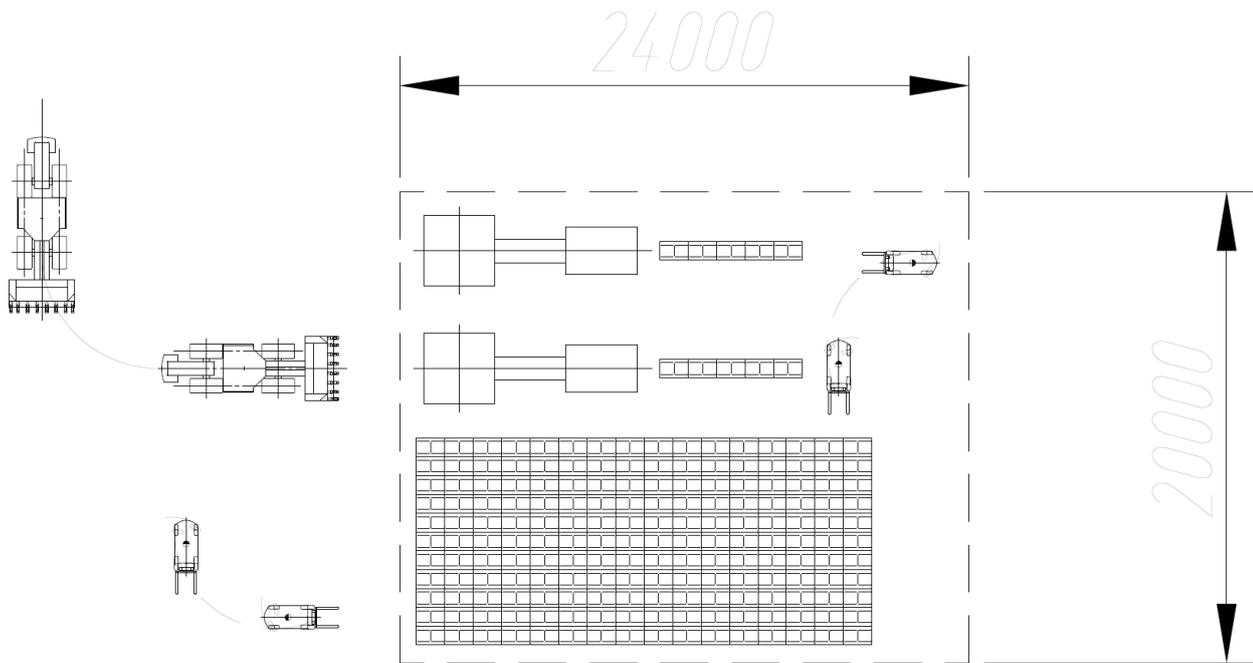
Принципиальная схема отгрузки фасованного угля
